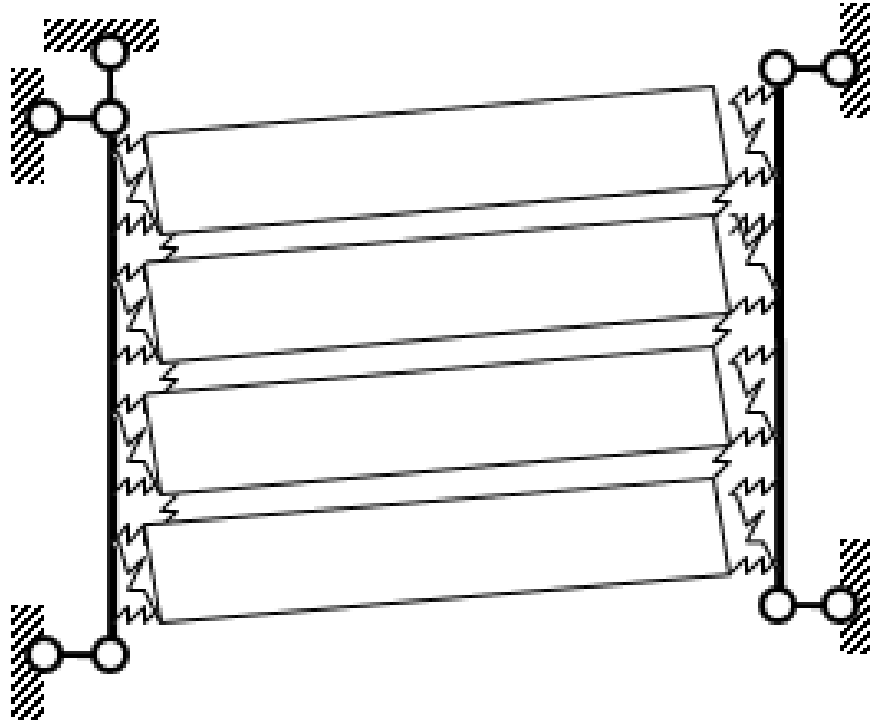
Схема деформирования расчетной модели ячейки перекрытия при отсутствии замоноличивания продольных швов.
